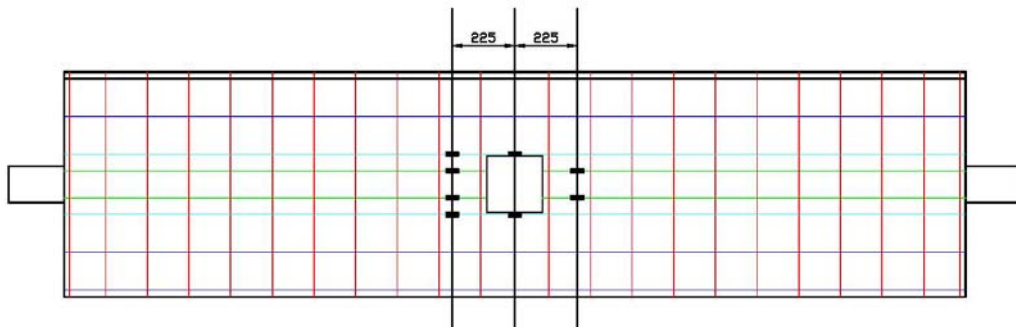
Localização dos extensômetros nas armaduras da laje do Modelo 2.
